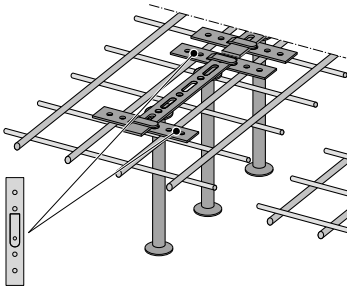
Colocação do pente HDB (-S) sobre a armadura superior da laje
